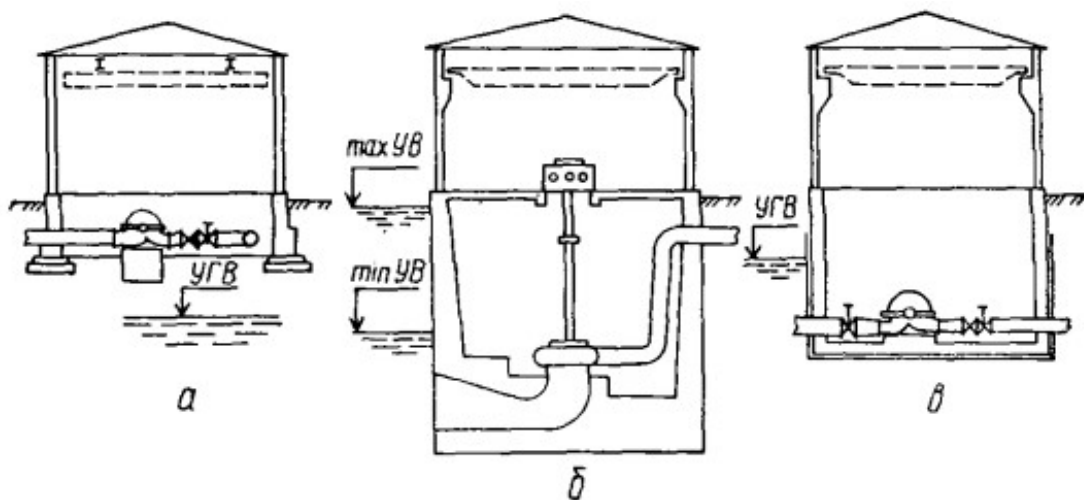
Типи конструкцій підземної частини насосних станцій: а — с раздельными фундаментами под оборудование и строительные конструкции; б — блочная; в — камерная
